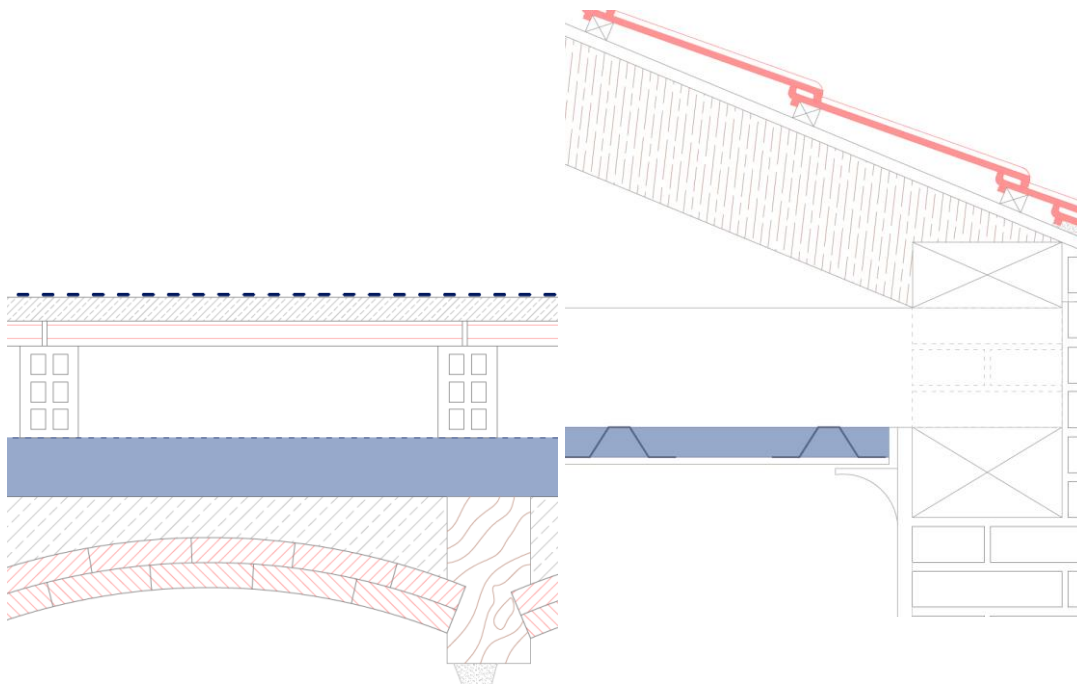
(izq.): detalle de la cubierta plana con aislamiento de XPS. Autora.
